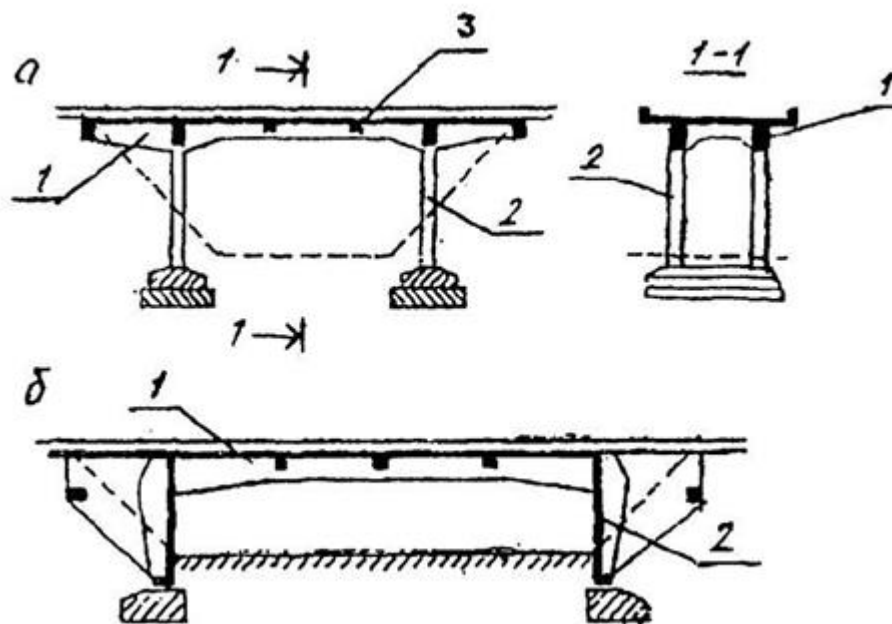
Схеми однопрогонових рамних шляхопроводів: а - з бічними консолями; б - як порталної рами; 1 - поздовжня (головна) балка; 2 - стійка (опора); 3 - поперечна балка
